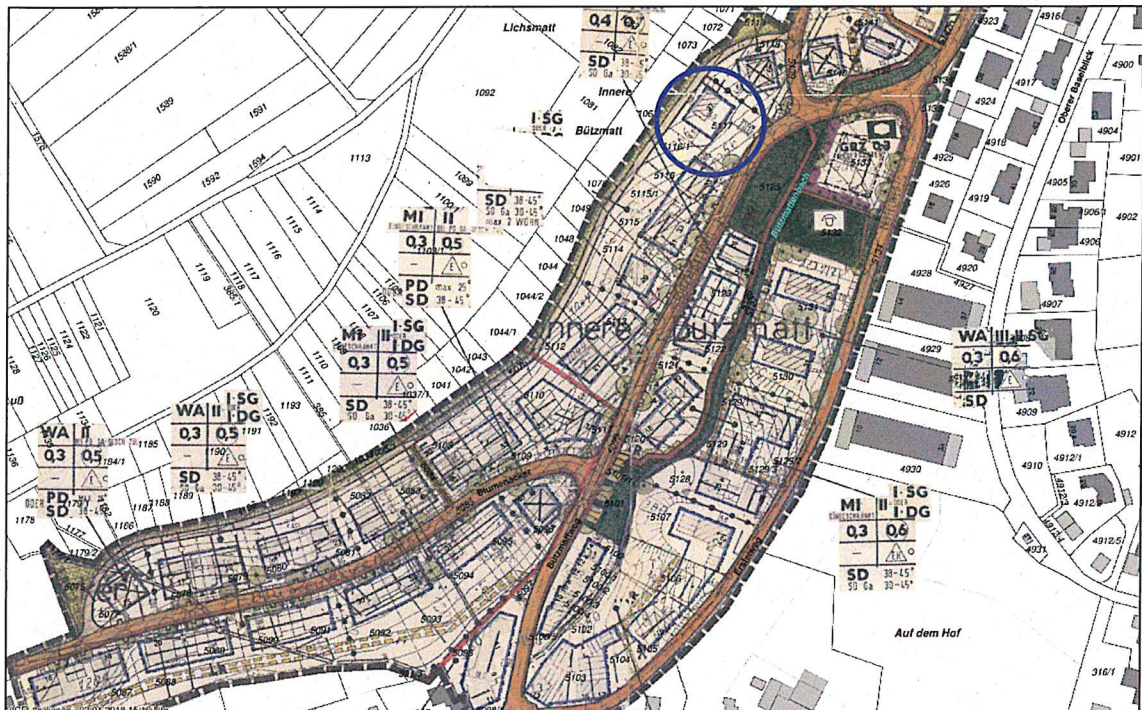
Bisher gültiger Bebauungsplan, Plangebiet blau markiert.
